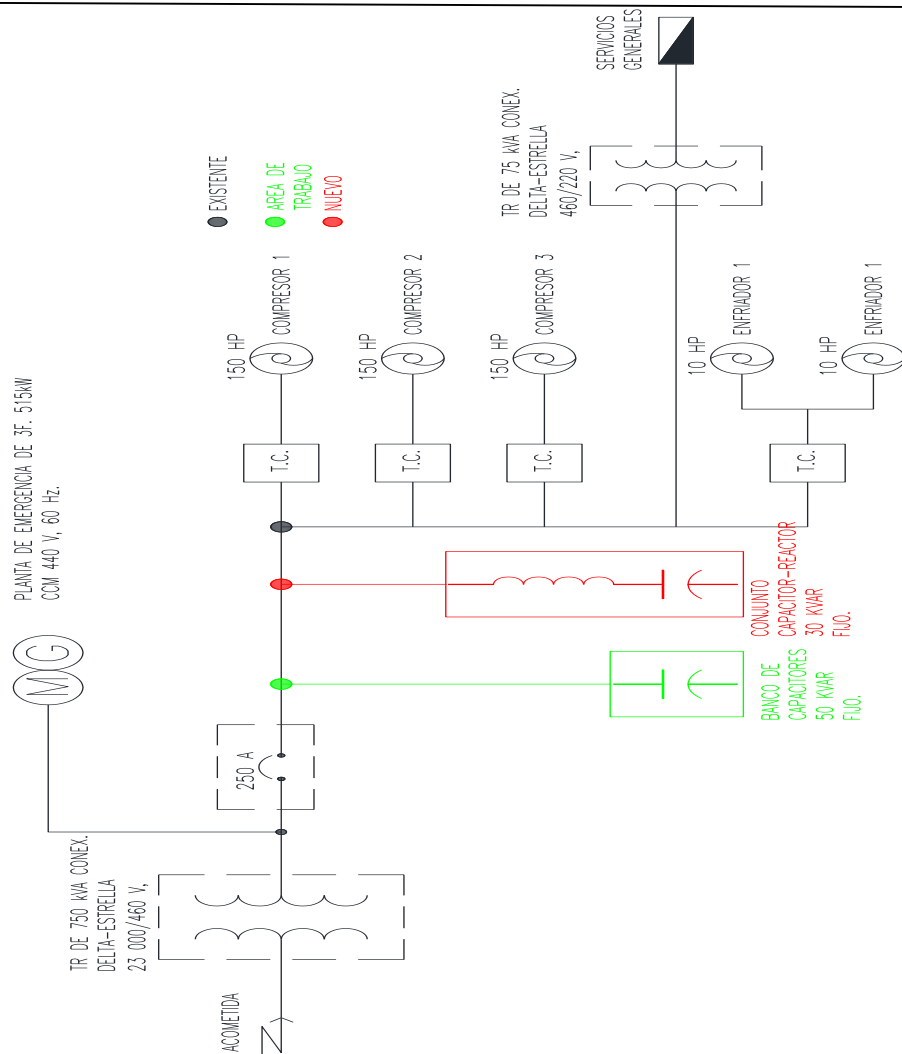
Diagrama unifilar de planta 1 con equipo propuesto tres
